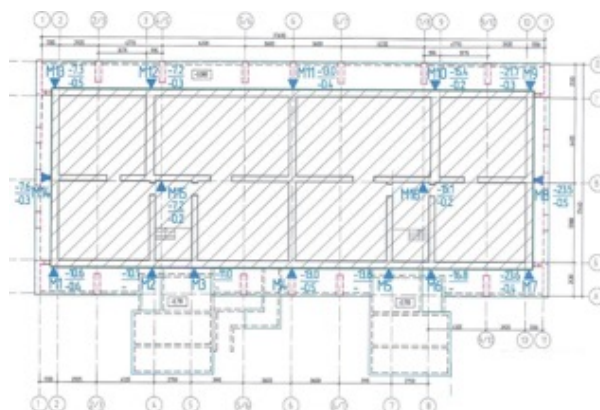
План-схема марок для наблюдений за осадками фундаментов реконструируемого здания.
